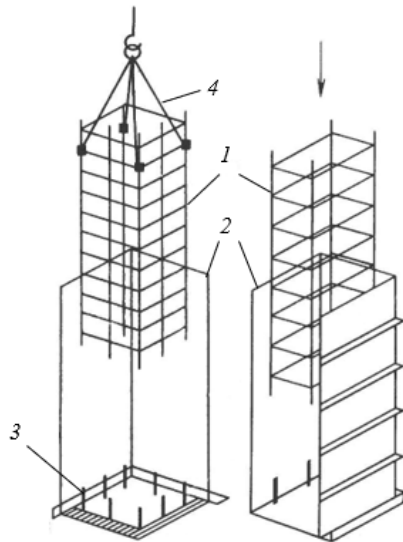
Монтаж опалубки колон: 1 — арматурні каркаси; 2 — щити опалубки; 3 — випуски арматури; 4 — стропувальний пристрій
